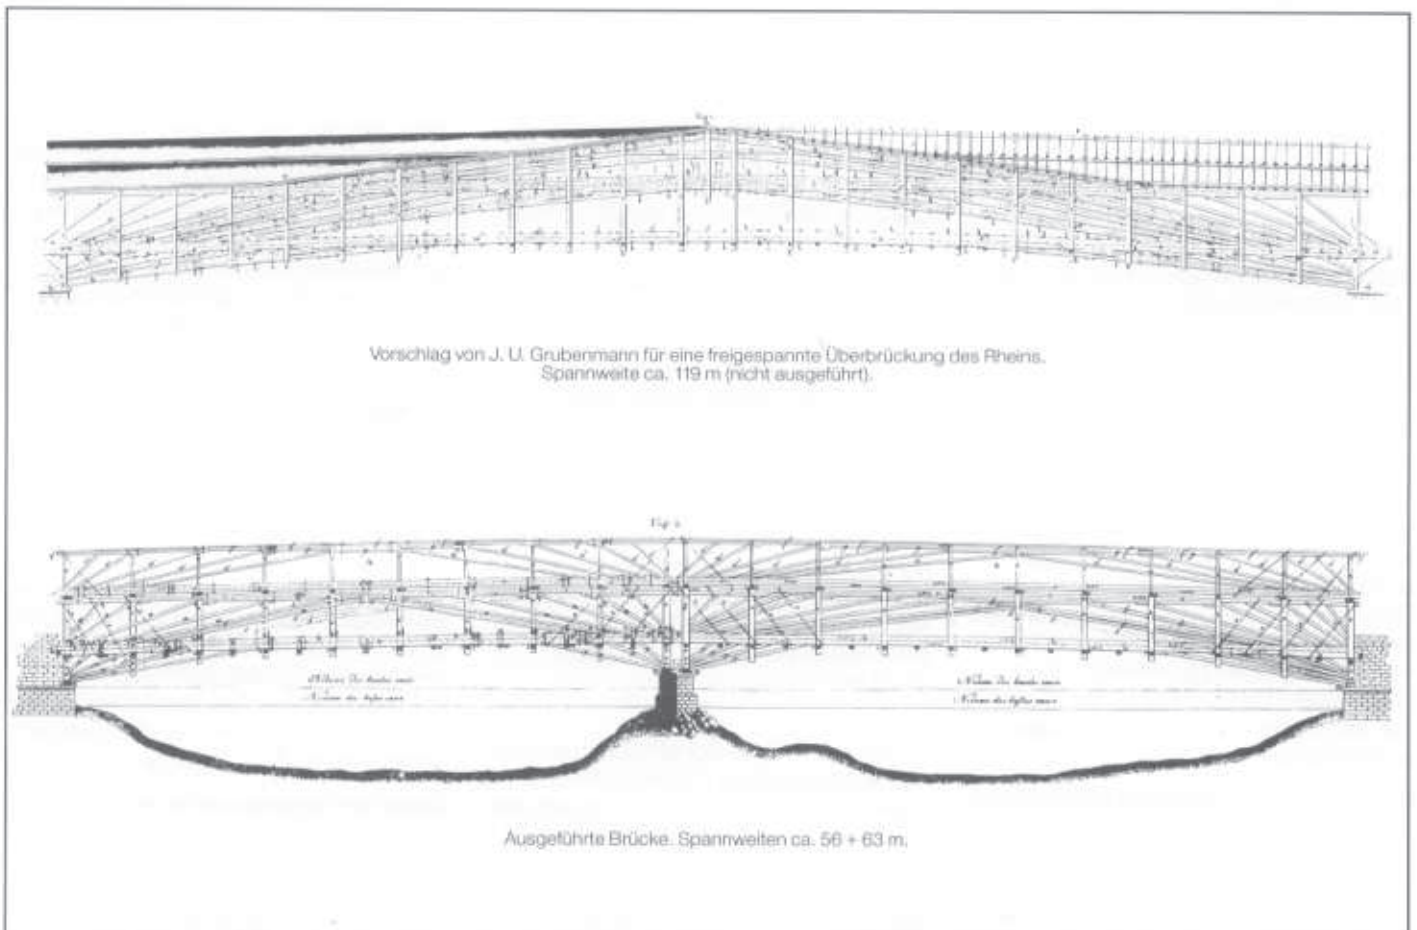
Brücke über den Rhein in Schaffhausen, 1756–58 nach [1/1]
